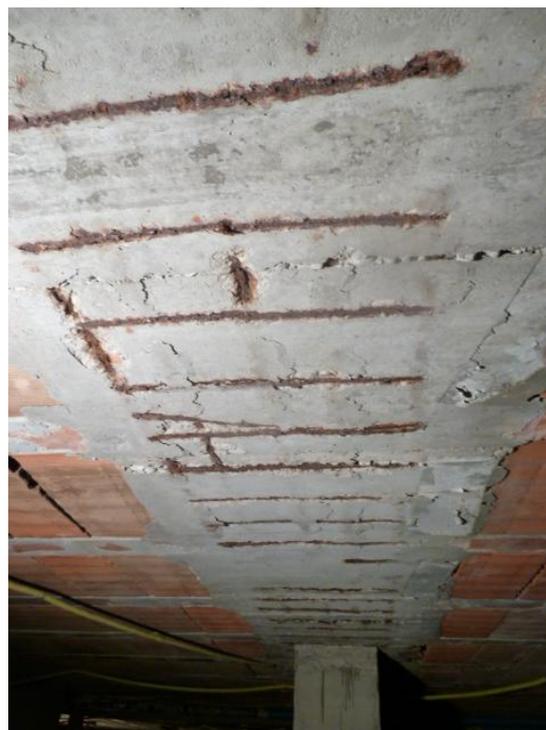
Oxidación/Corrosión del armado inferior de viga de forjado. Deficiente recubrimiento del armado.
